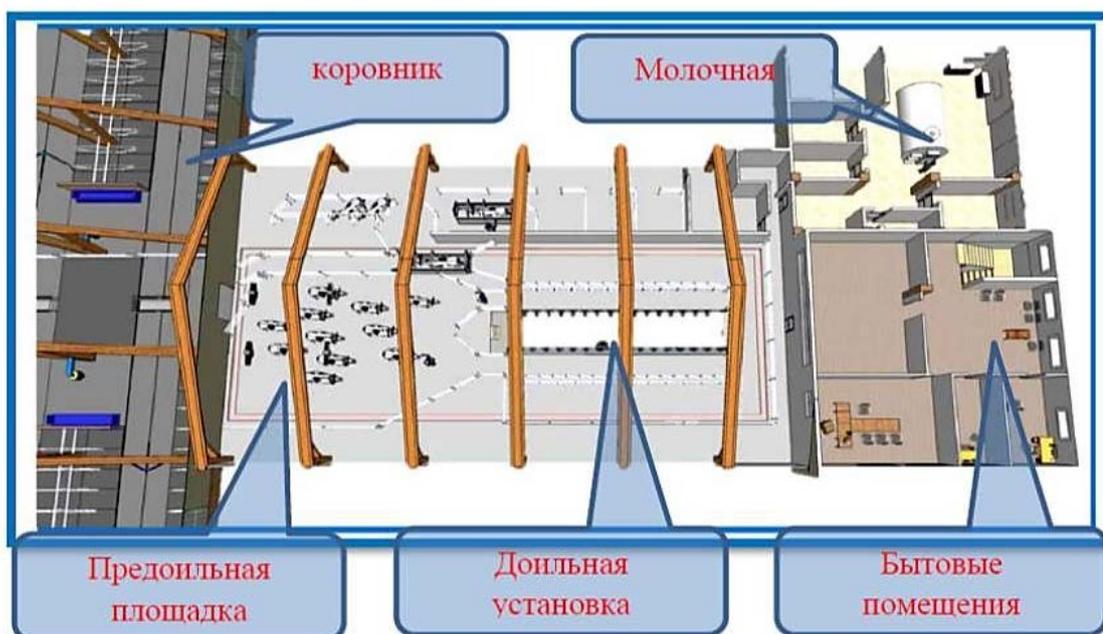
Схема размещения доильной площадки в отдельном помещении
